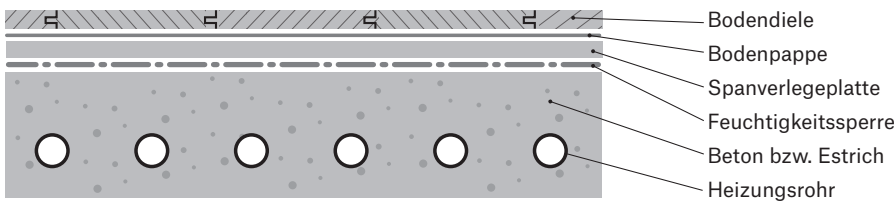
Querschnitt Sperrholz/Spanverlegeplatte auf Beton bzw. Estrich mit Heizungsrohren
